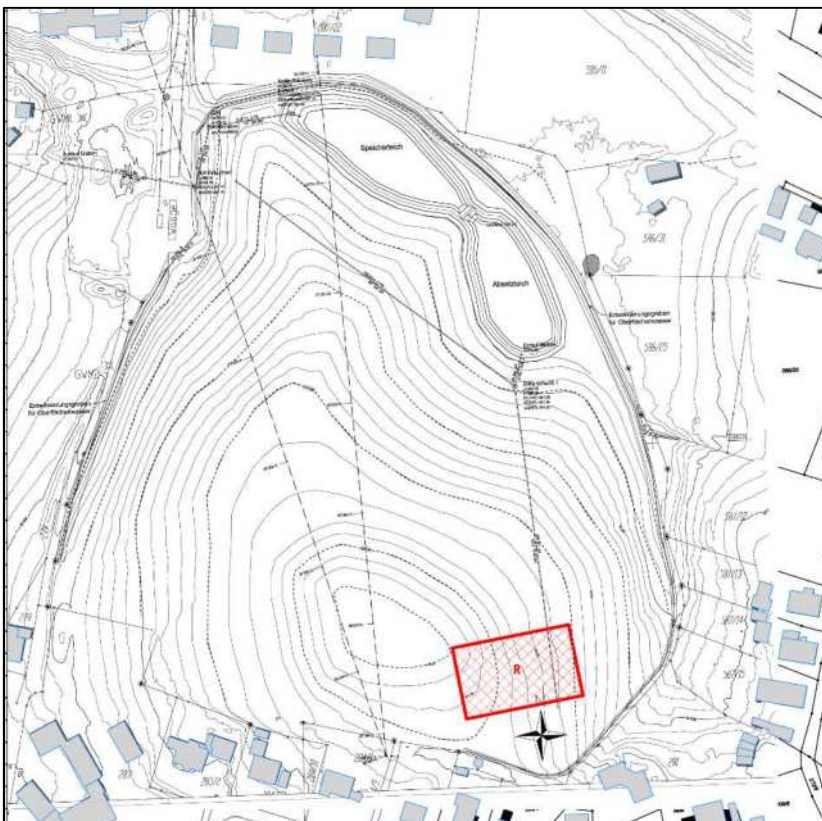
Lageplan mit Darstellung der relevanten Schallquellen – Variante 4
